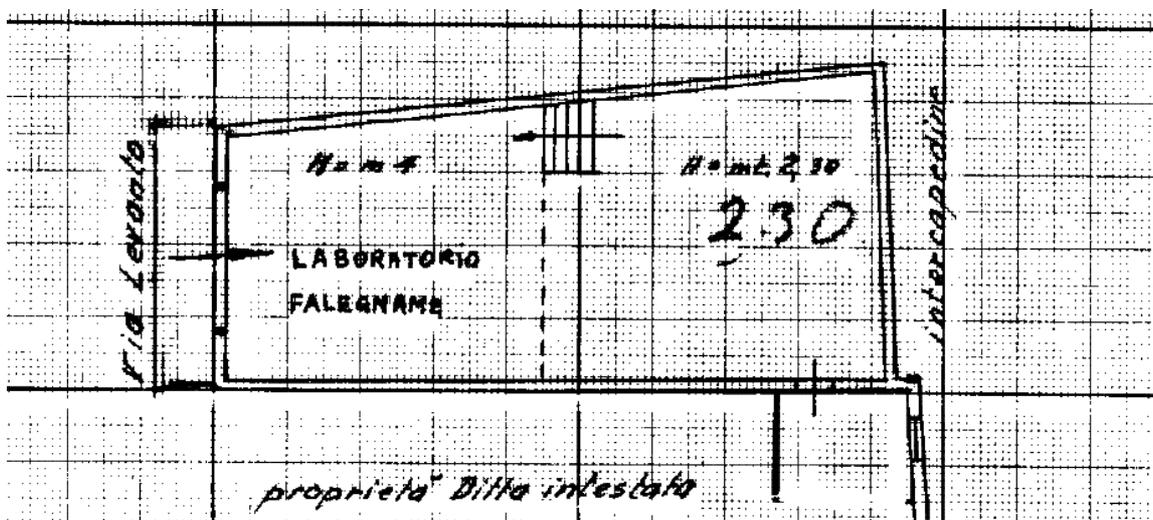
STRALCIO PLANIMETRICO DELL'U.I.U. OGGETTO DI ANALISI (FONTE: INTERNA).
